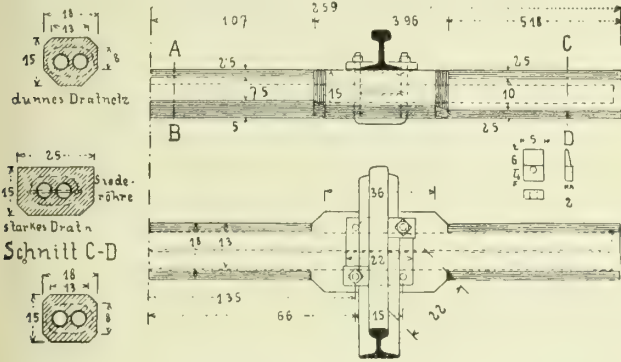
Eisenbeton-Schwelle R. B. Campbell
